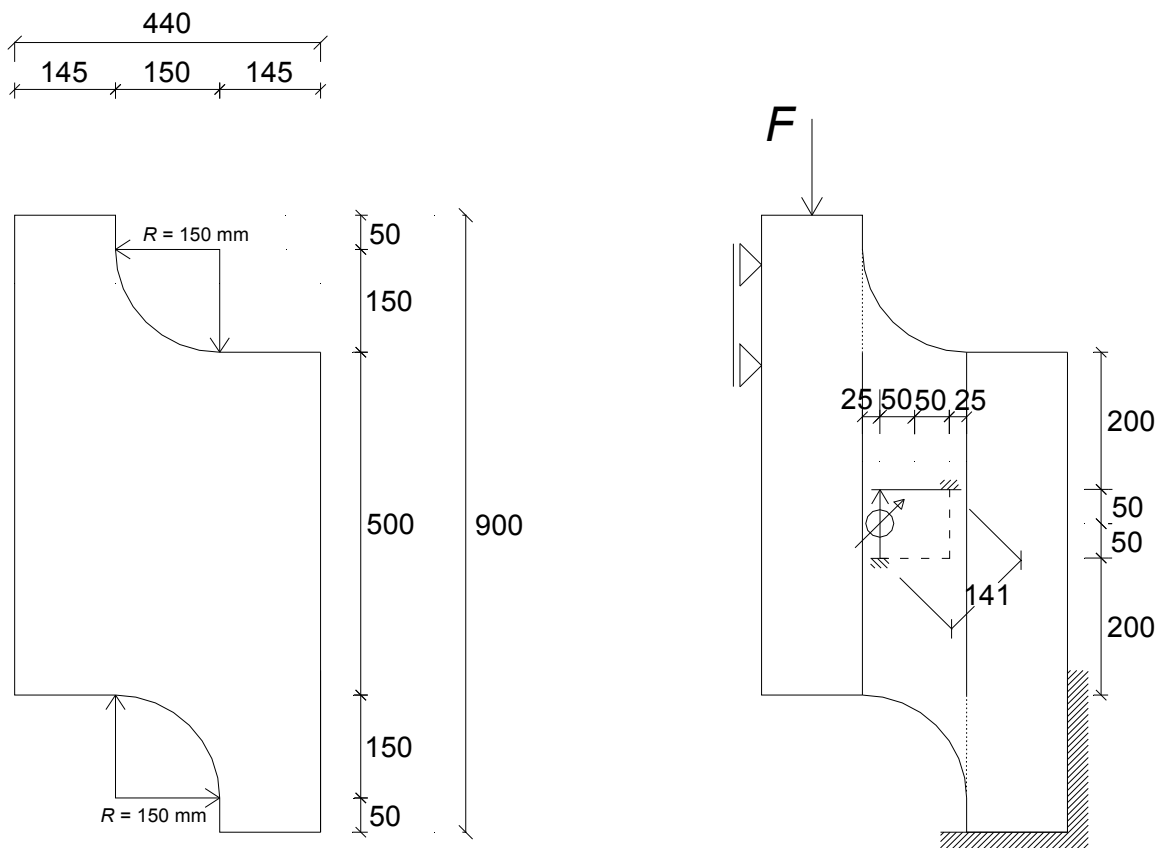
Versuchskörpergeometrie und Versuchsdurchführung (Maße in mm)
